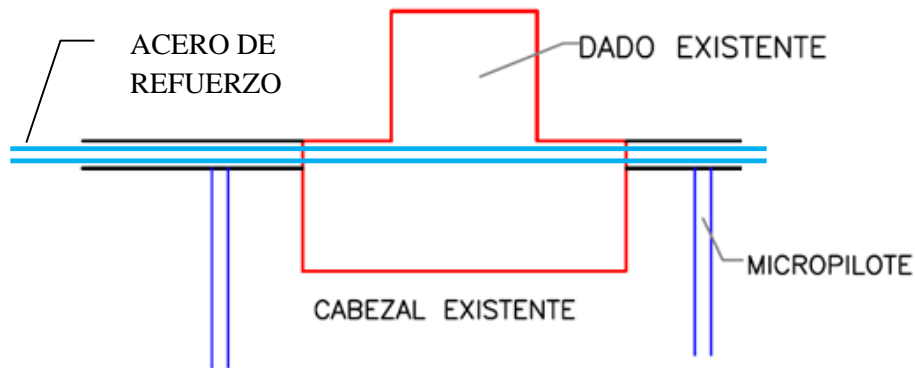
Detalle en corte transversal de la unión estructural entre el cabezal, dado de concreto, losa de cimentación y los micropilotes.
